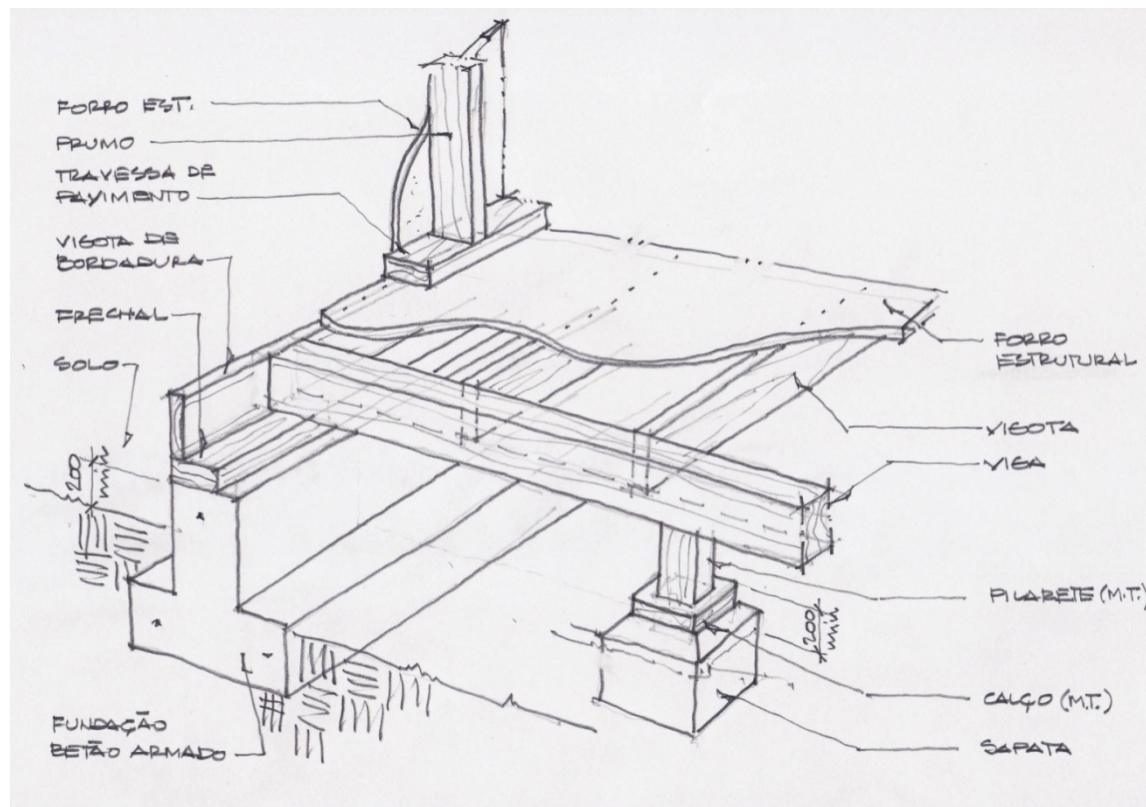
Protecção contra a deterioração da construção através dos afastamentos da madeira ao solo. (des. autor)
